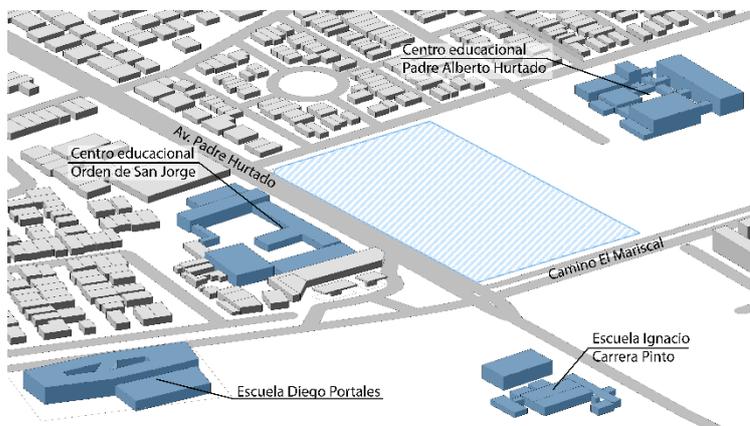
Plano ubicación Distrito 6. Elaboración propia
